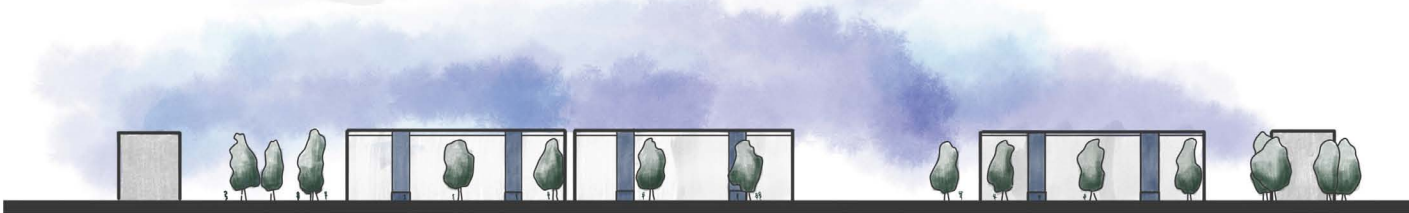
Plano de conjunto de las áreas verdes dentro de la propuesta.
